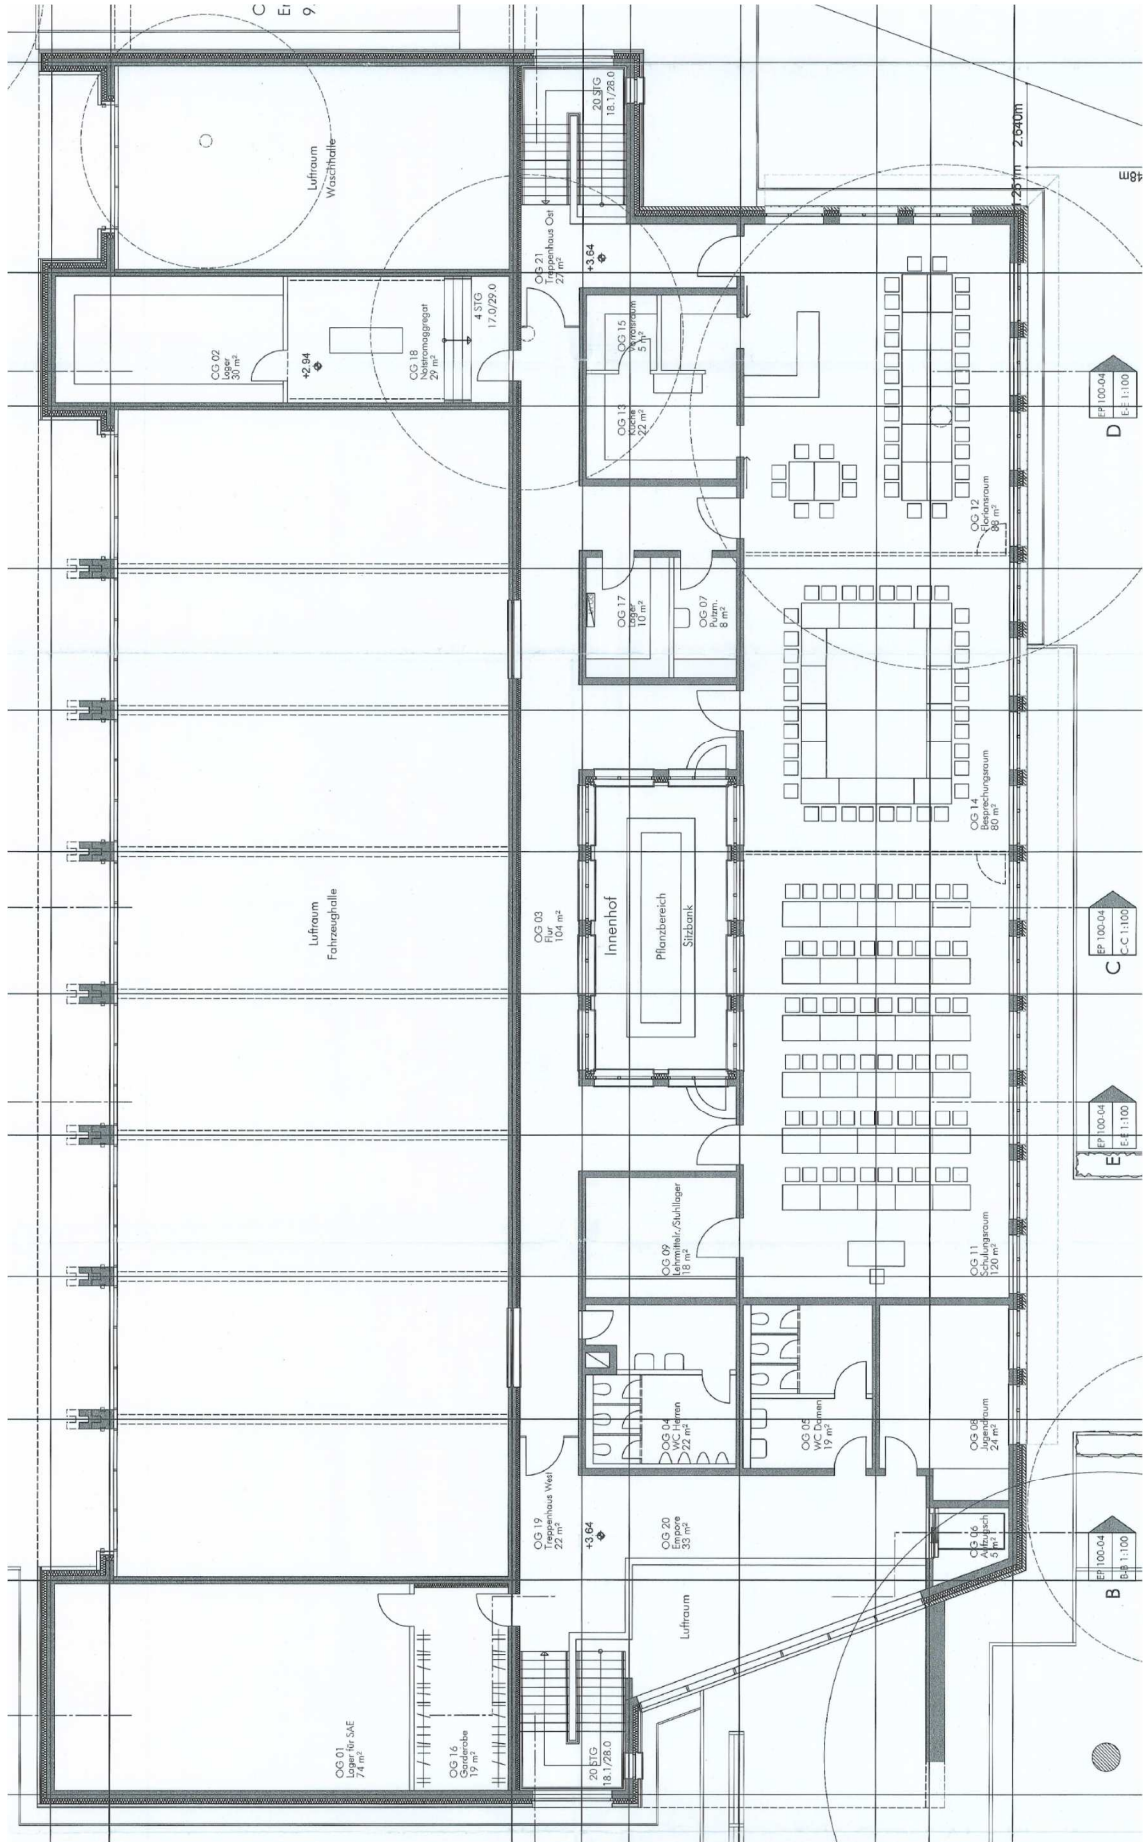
Neubau Feuerwehrhaus Büttgen Grundriss Obergeschoss
